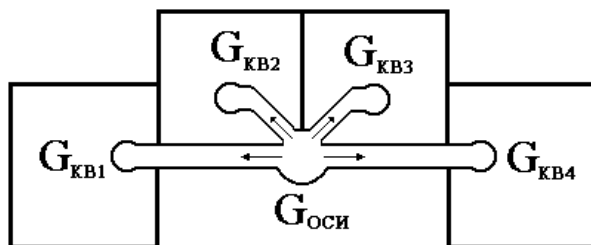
Принципиальная схема разводки горячей воды на отопление на этаже
